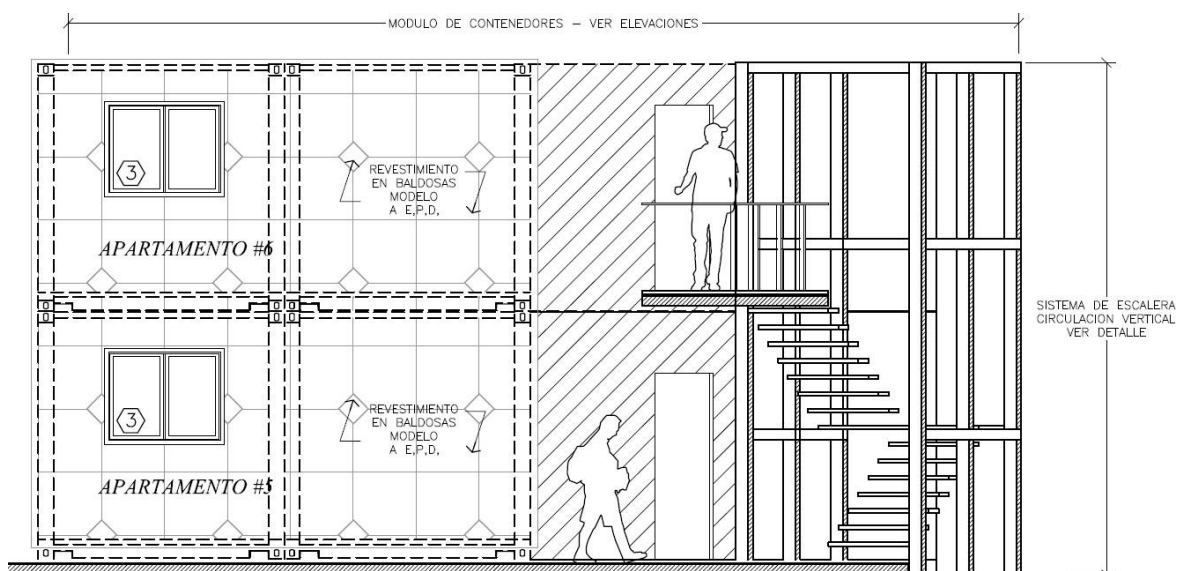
Elevación Lateral – Fachada hacia Avenida 9ª Oeste
